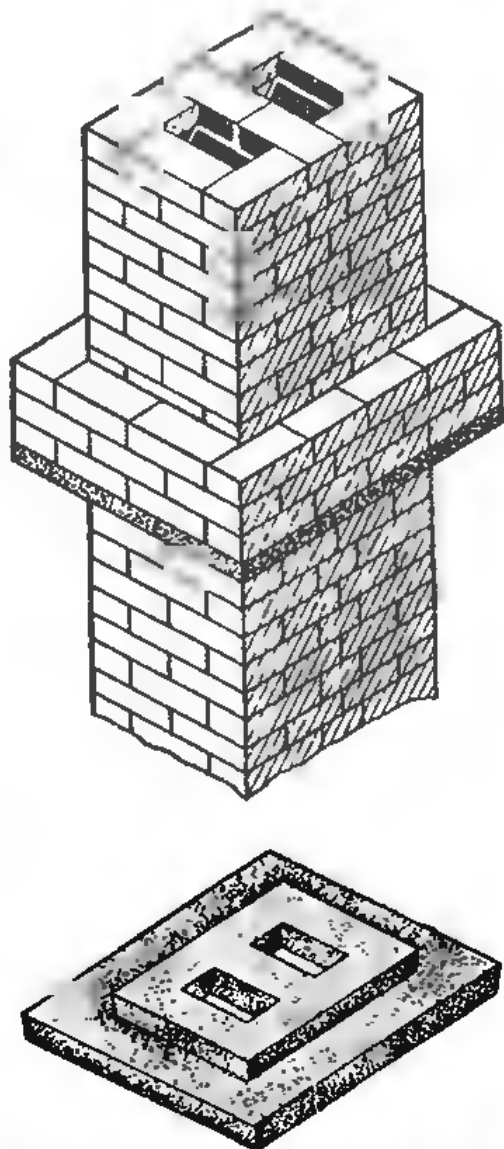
Устройство железобетонной плиты в качестве разделки при пропуске дымовой трубы через перекрытие
